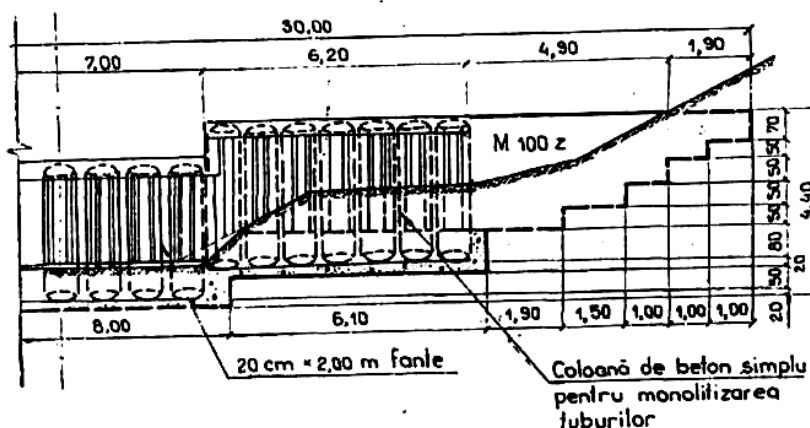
Baraj din tuburi prefabricate din beton B300 umplute cu materiale locale(Varianta V.Părău)
